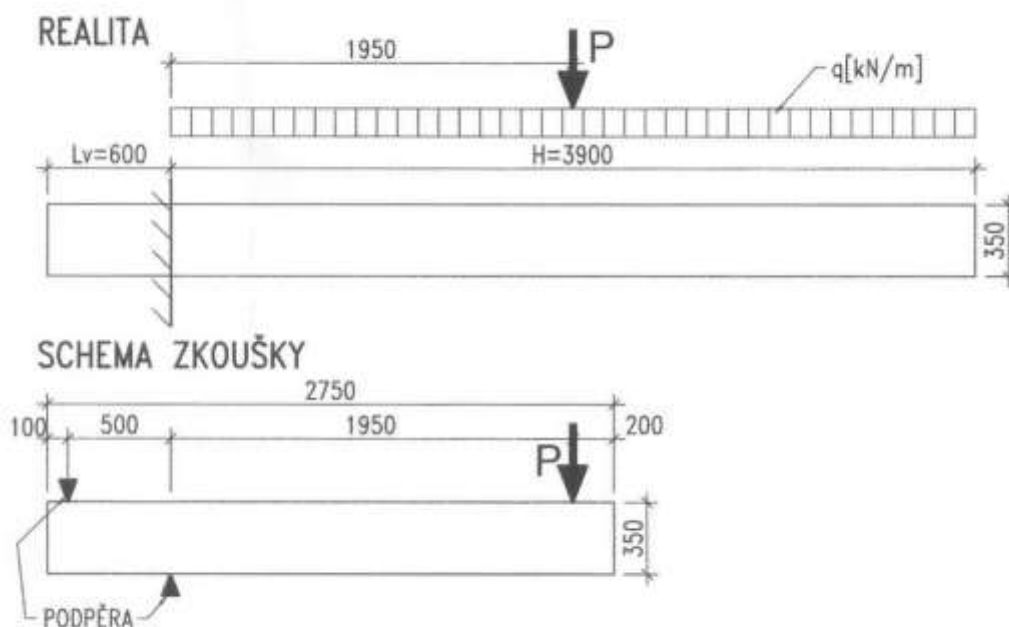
Schéma průřezu předpjatého drátkobetonového sloupku protihlukových stěn
